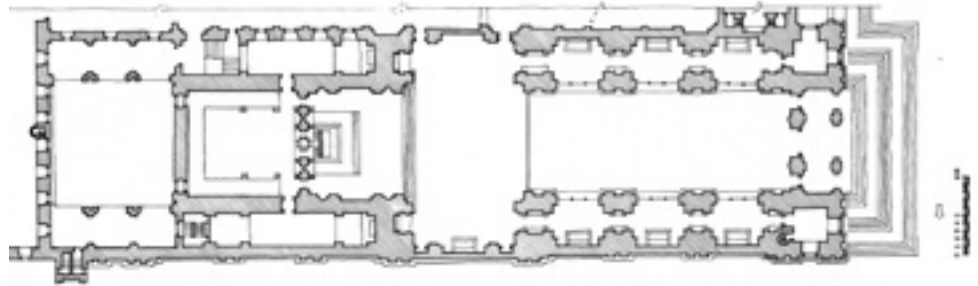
S. Vicente de Fora, Lisboa, 1582-1629 – planta da igreja. (in Kubler 1988, 84).
